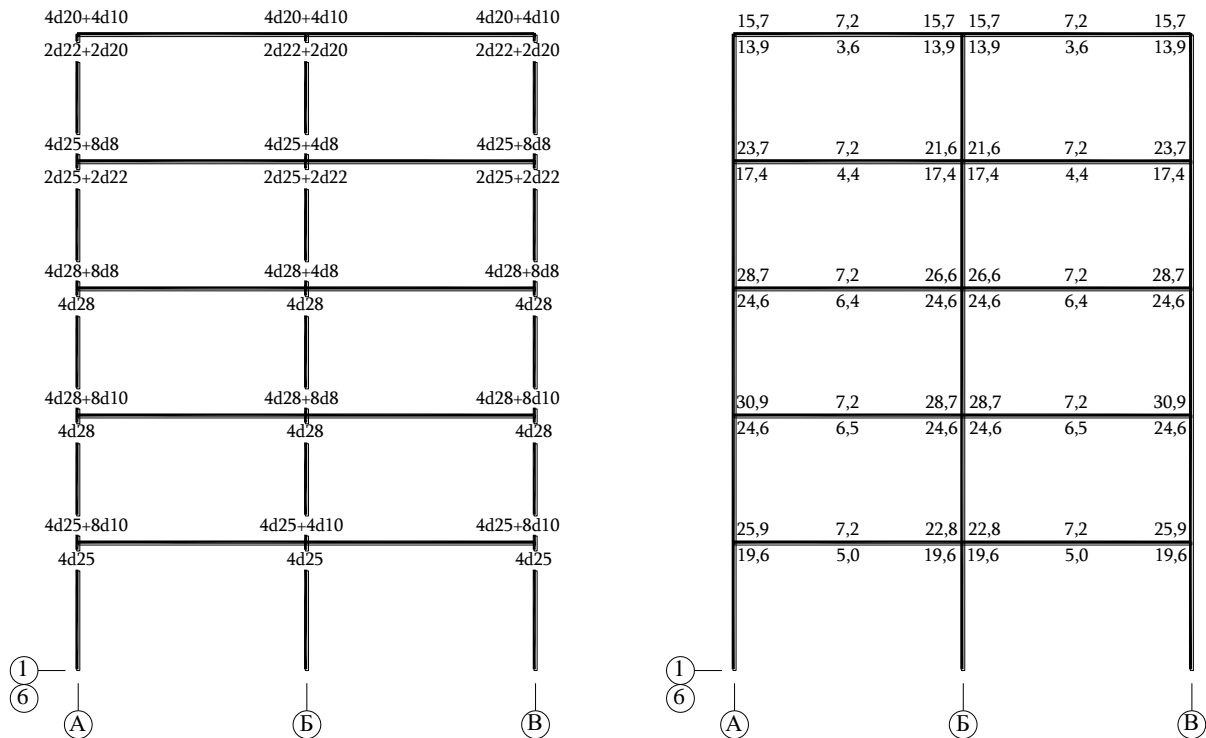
Продольное армирование балок рам, расположенных по осям 1 и 6, в соответствии с результатами конструирования:
